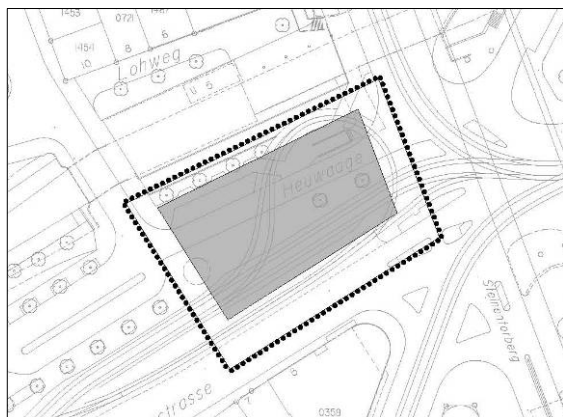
Bebauungsplan Heuwaage, Plan Nr.13'354.
